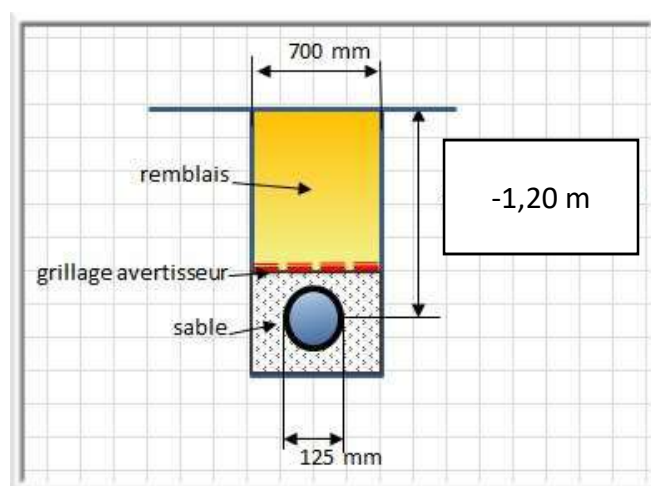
Coupe transversale de l'enfouissement d'une conduite
